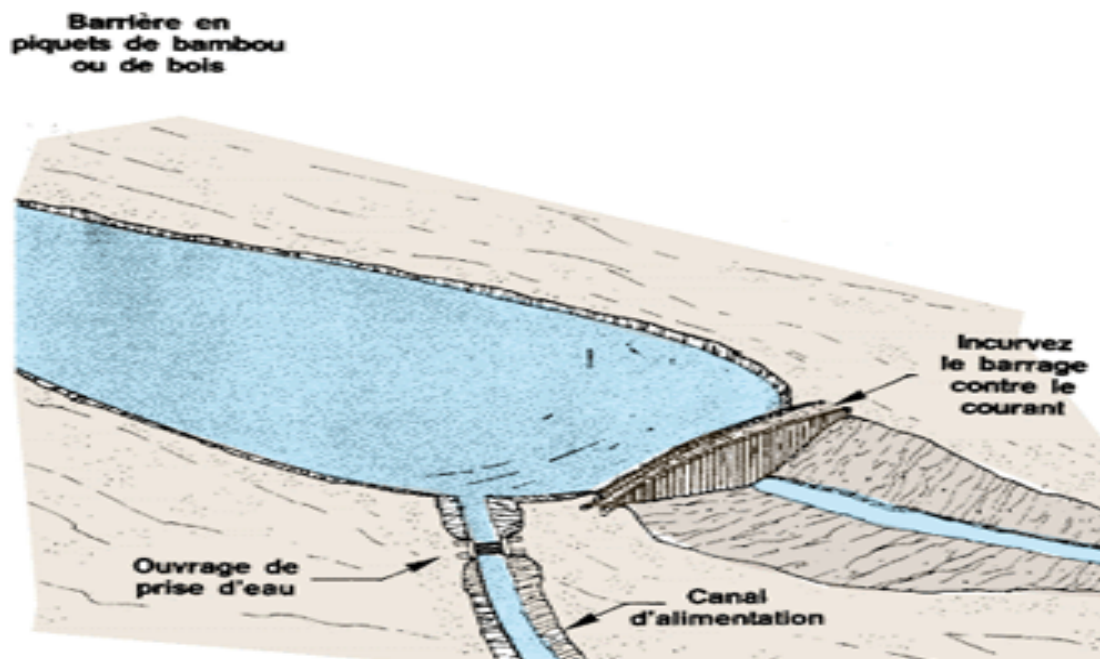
ouvrage de prise d'eau un barrage en piquets
